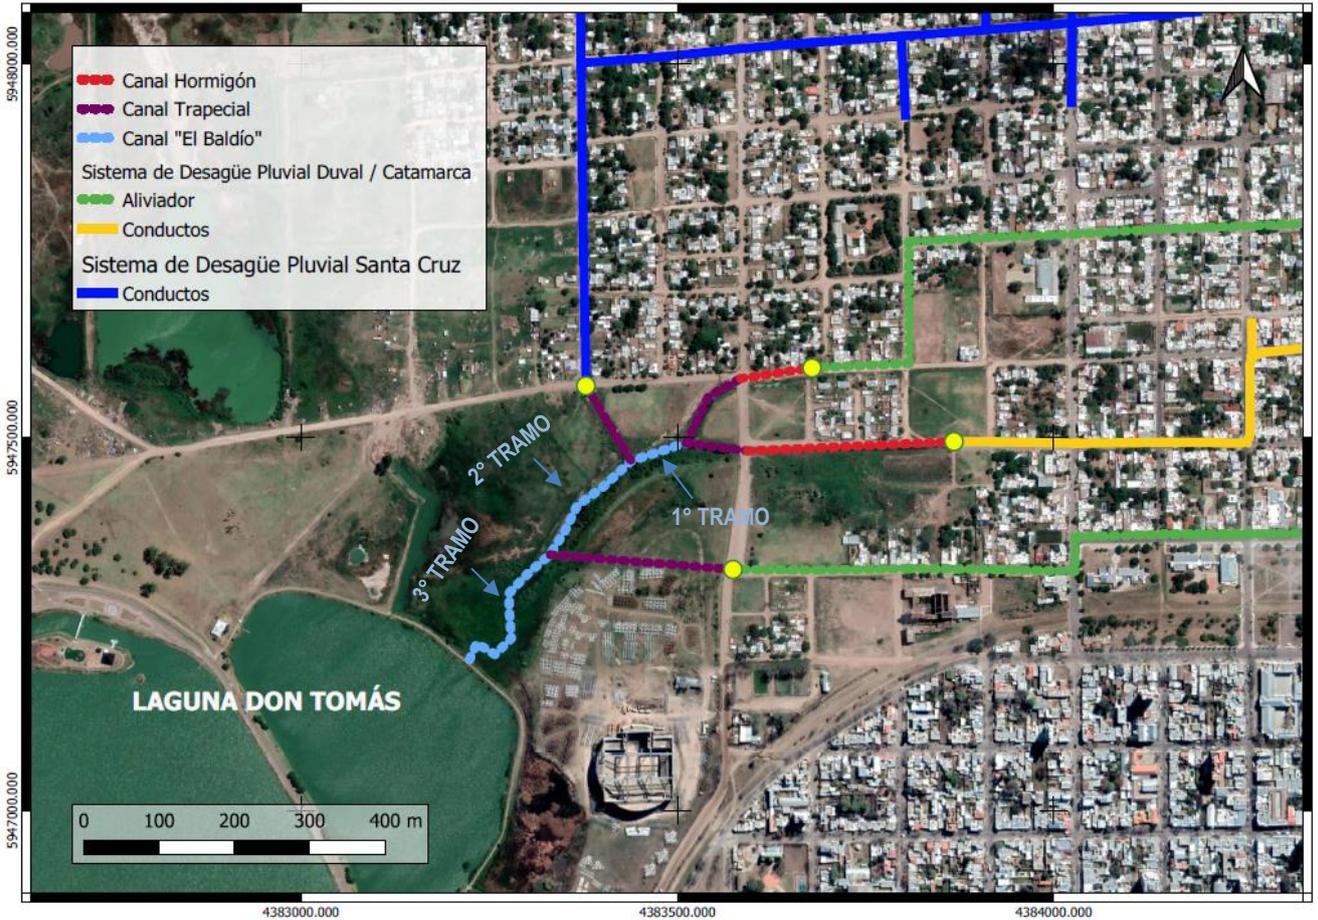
Punto de vuelco para Sistema de Desagüe Pluvial Santa Cruz
